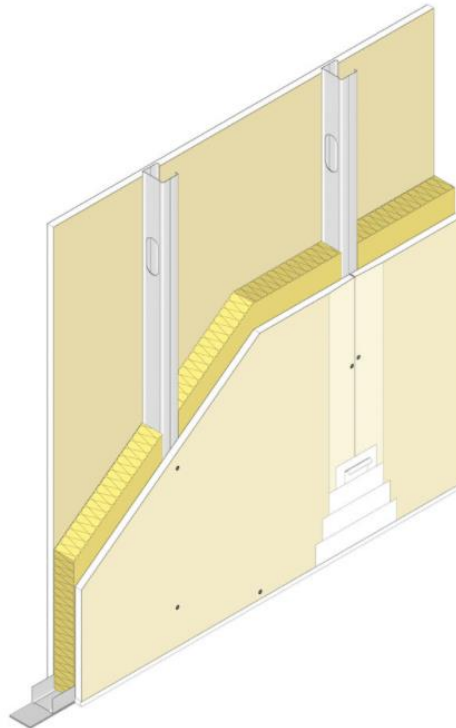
Pladur estructurat 100 mm. Pladur Gypsum, 2021.
